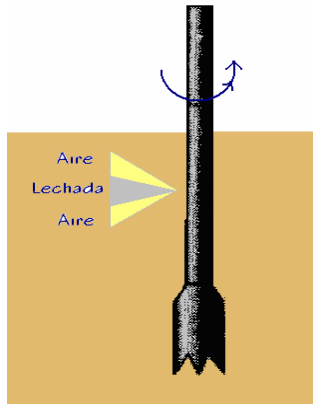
84. Esquema del sistema de jet grouting de barra simple (S)
